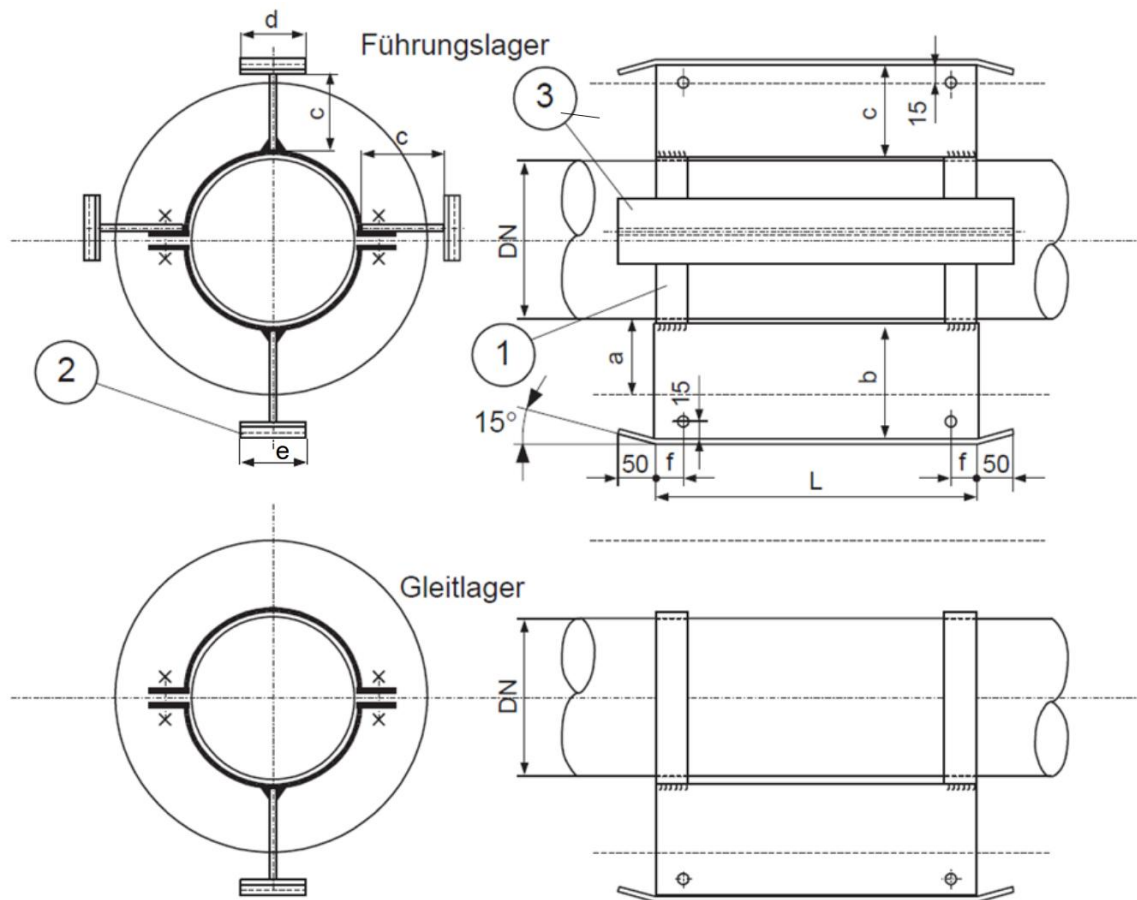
Führungs- und Gleitlager in Hausstationen und Fernleitungen
